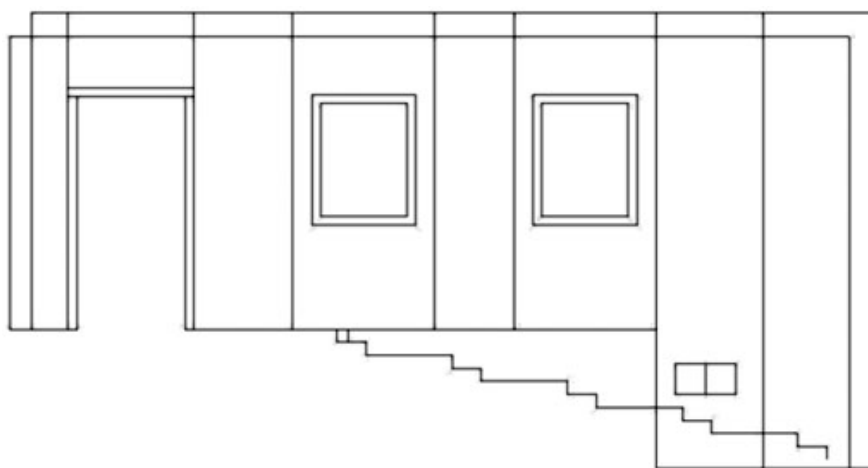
Prospetto nord della cabina di Barcis. Si noti come il foro della porta sia realizzato mediante l'assemblaggio di tre diversi pannelli doppia lastra.
